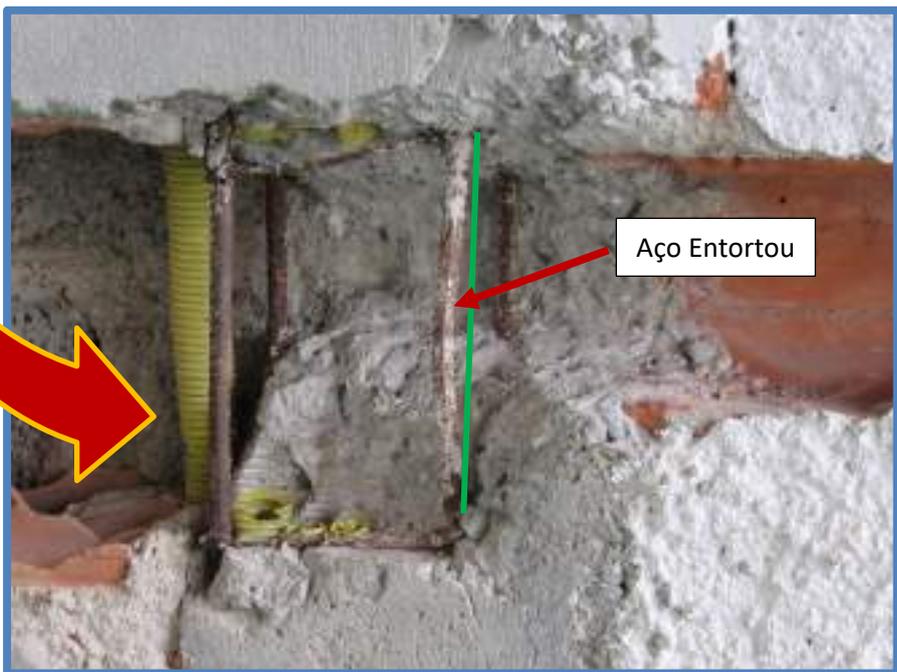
Casa do Pavimento Térreo, Pilar cortado.
